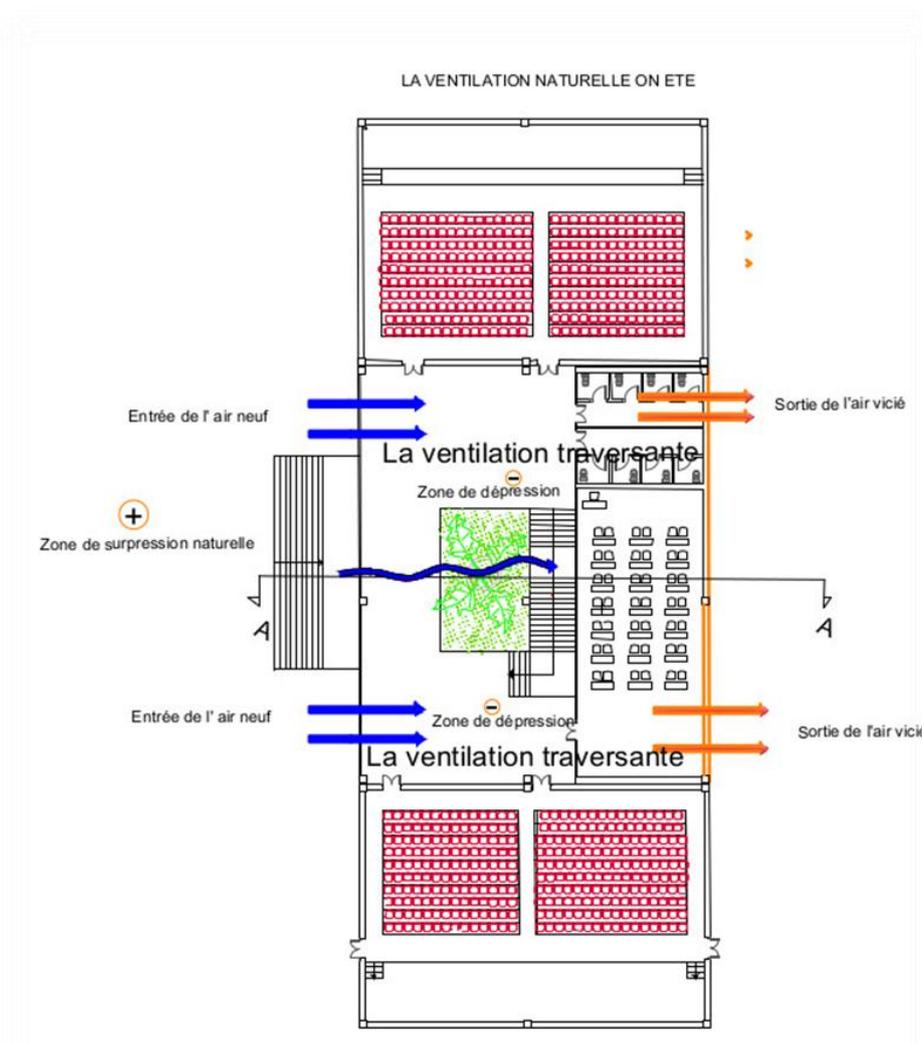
le plan de la ventilation traversante dans le projet .Source : Auteurs
